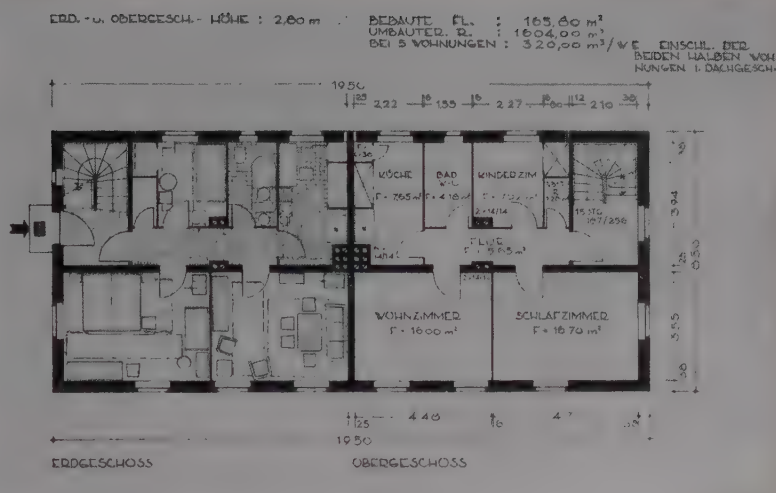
Zweigeschossiges 2½-Zimmer-Vierfamilienwohnhaus für Landarbeiter, Vorschlag für Mitteldeutschland, Grundriß Erdgeschoß und Obergeschoß
